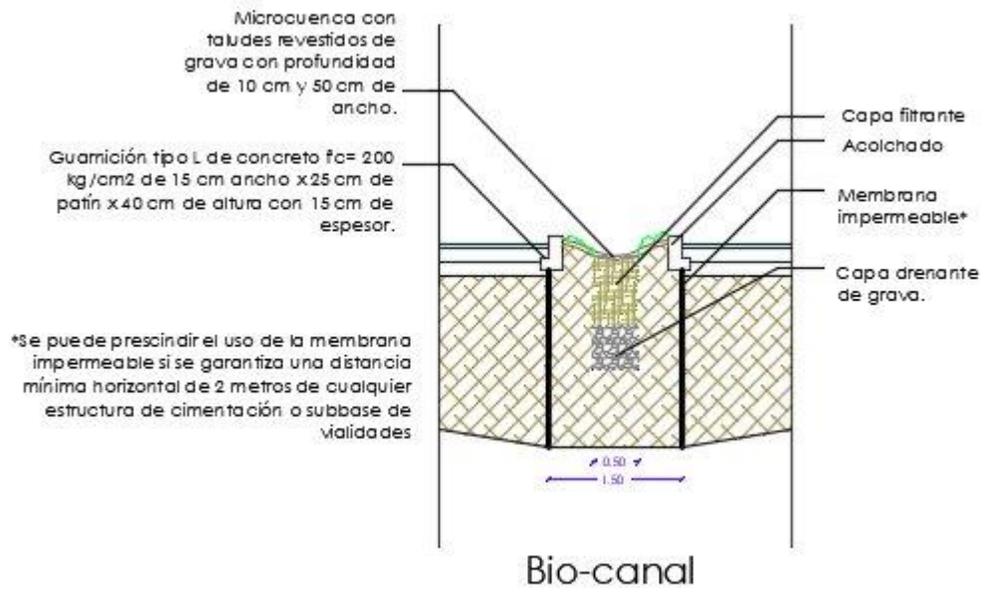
Detalle constructivo de Bio-canal en camellón Fuente: Elaboración propia.
